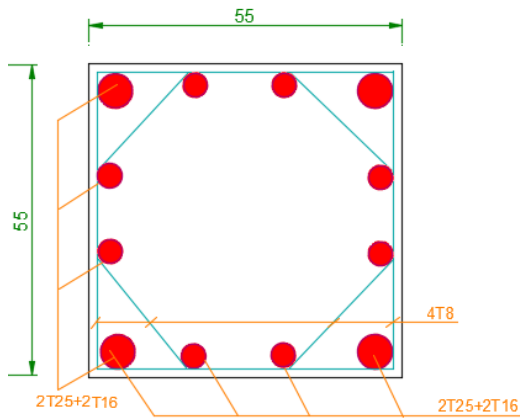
Schéma De Ferrailage Des Poteaux de 6^{eme} et 7^{eme} étages.
